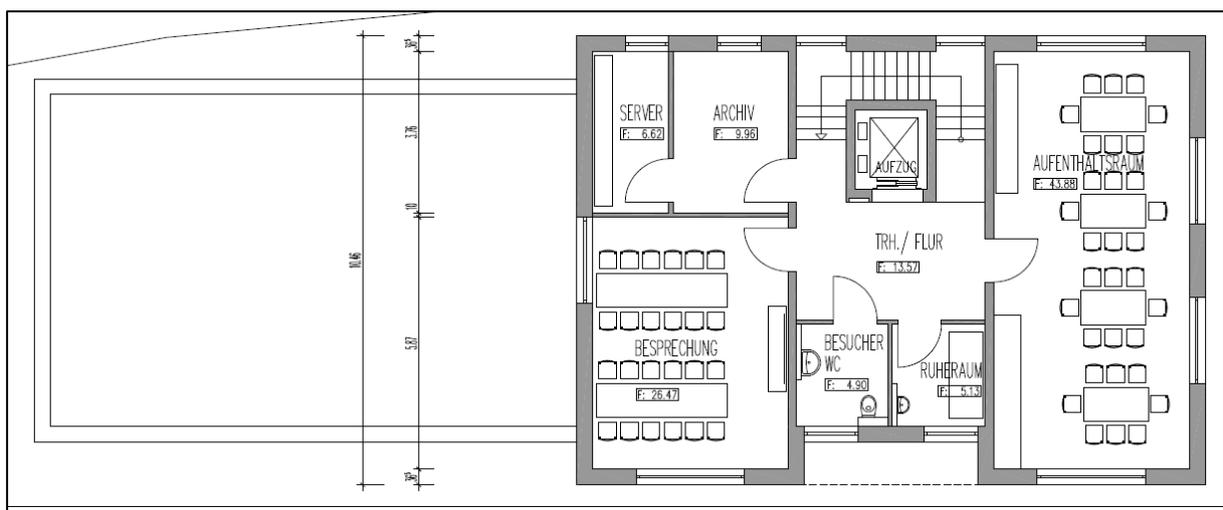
Vorentwurf eines zweigeschossigen Betriebsgebäudes - Obergeschoss
